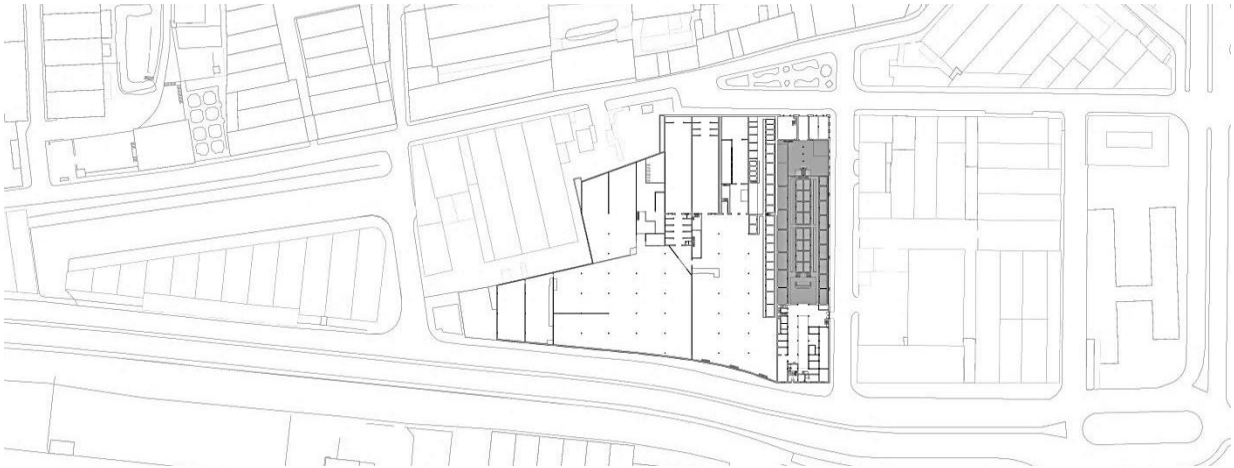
Planta de levantamento fotográfico piso intermédio – Armazém 2.
